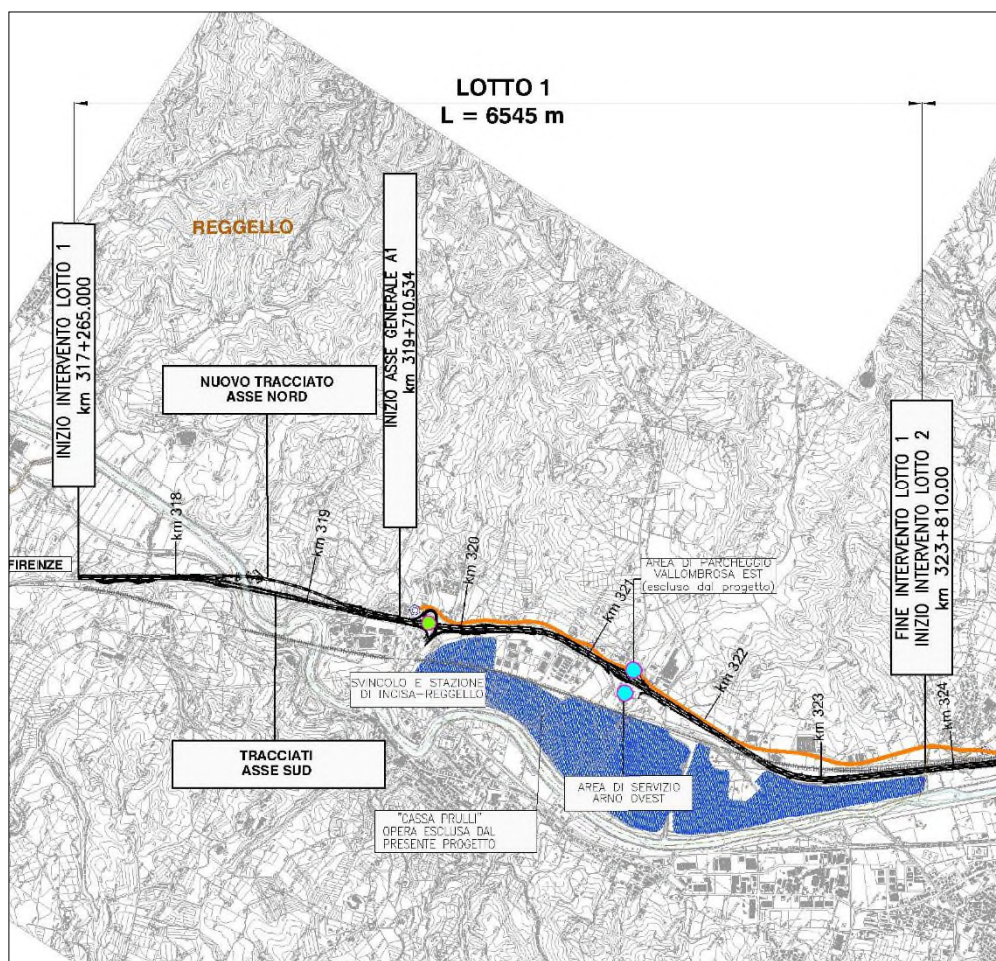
Lotto 1: stralcio planimetrico da STD0015 per l'inquadramento generale di intervento
